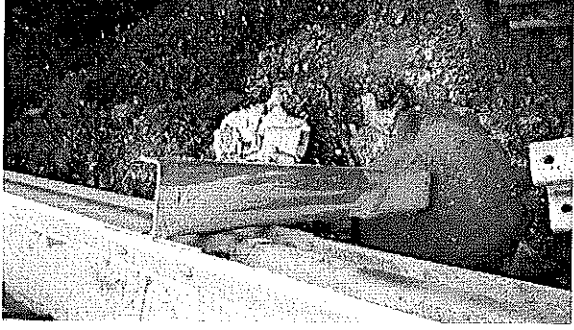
Saturación y Socavación material soporte de cuneta
